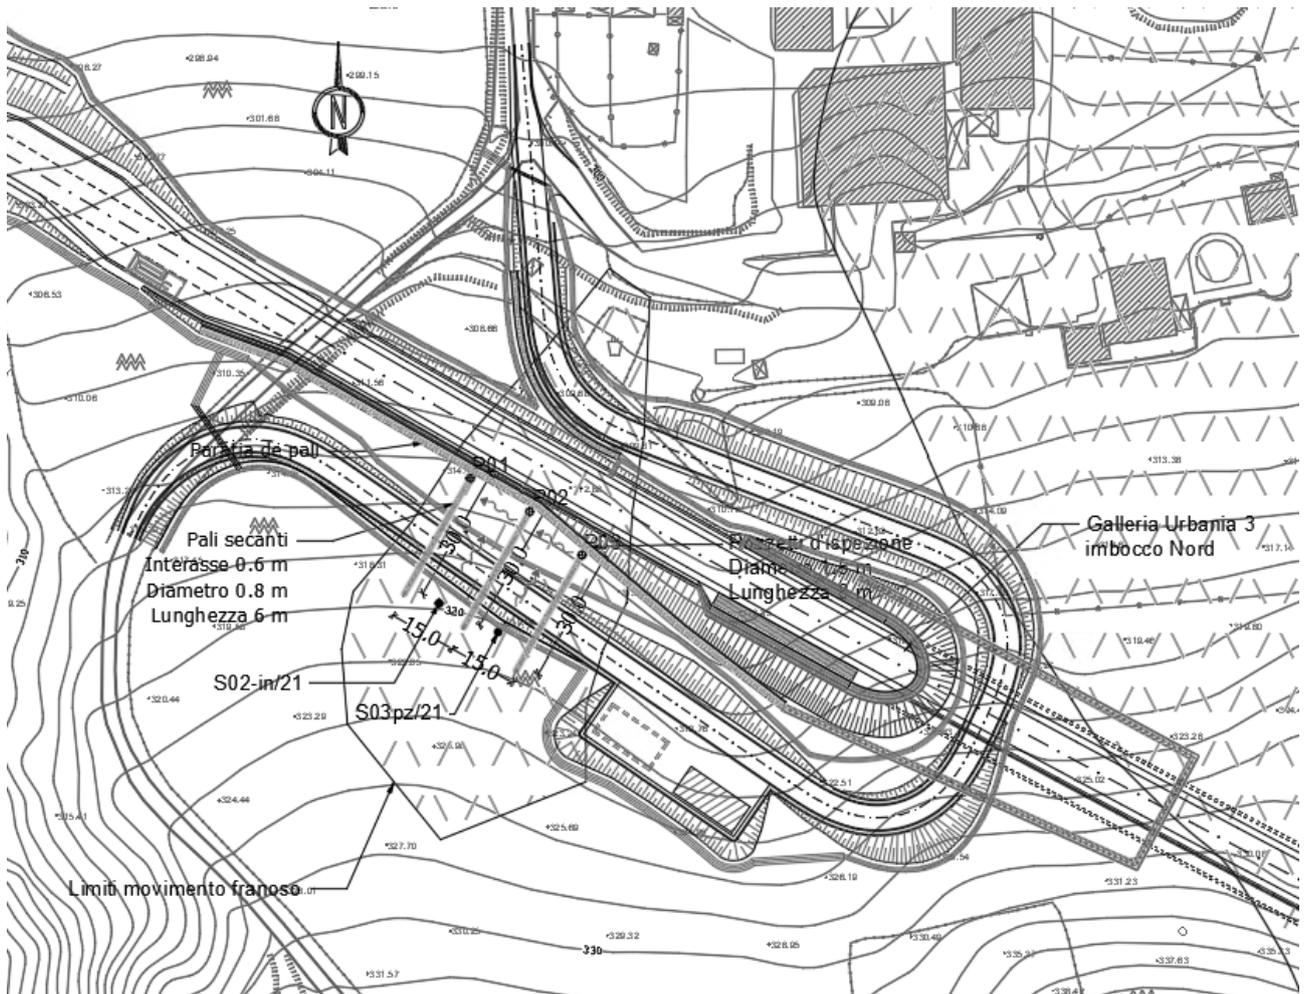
Schema della disposizione in pianta del sistema drenante costituito da pali secanti
